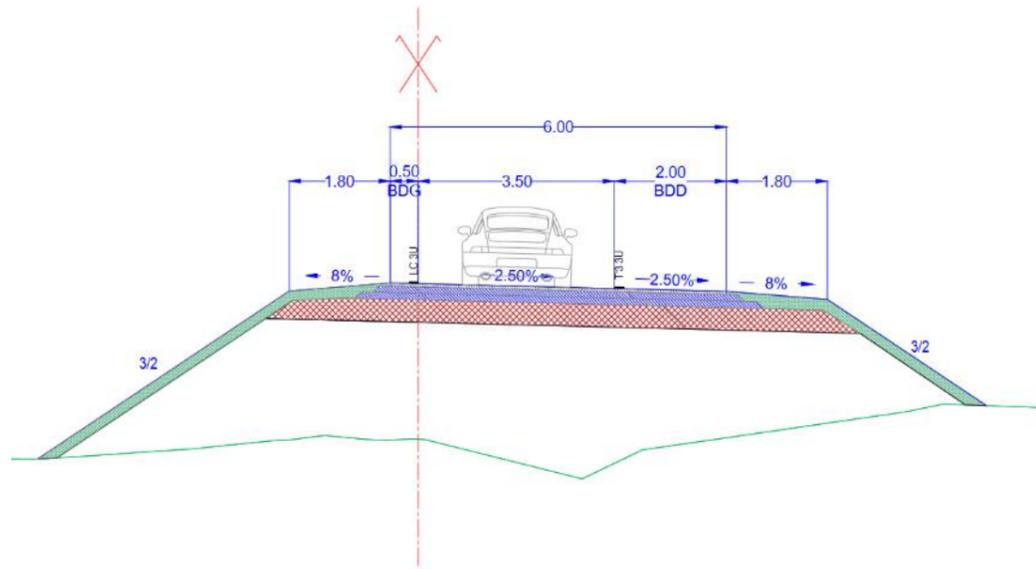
Profil en travers type d'une bretelle (largeur en mètres)
